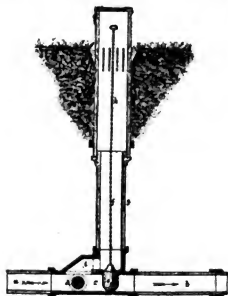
Ventil für die Petersen'sche Wiesenbewässerung.
